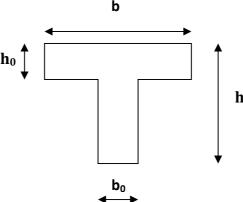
COUPE TRANSVERSALE D'UNE POUTRELLE
